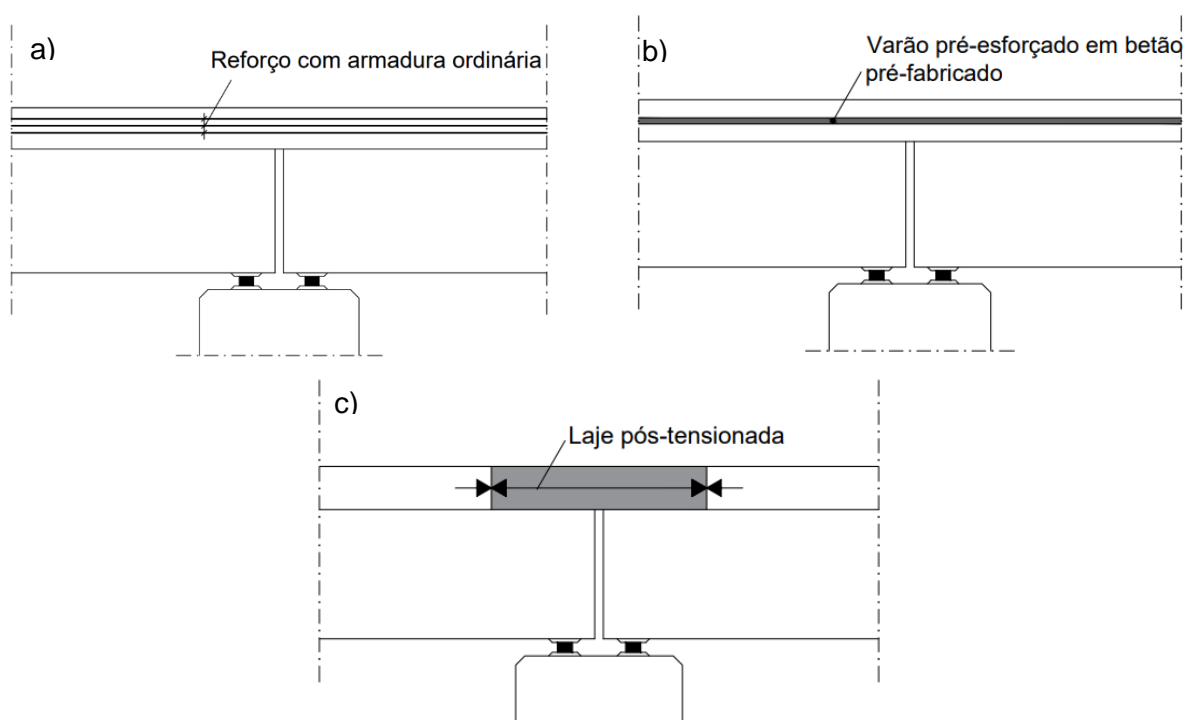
Continuidades parciais de tabuleiros com vigas pré-fabricadas. a) Reforço da laje por armadura ordinária b) Recurso a varões pré-esforçados em betão pré-fabricado c) Recurso a laje pós-tensionada. Fonte: Adaptado de Jayananda 1989.
